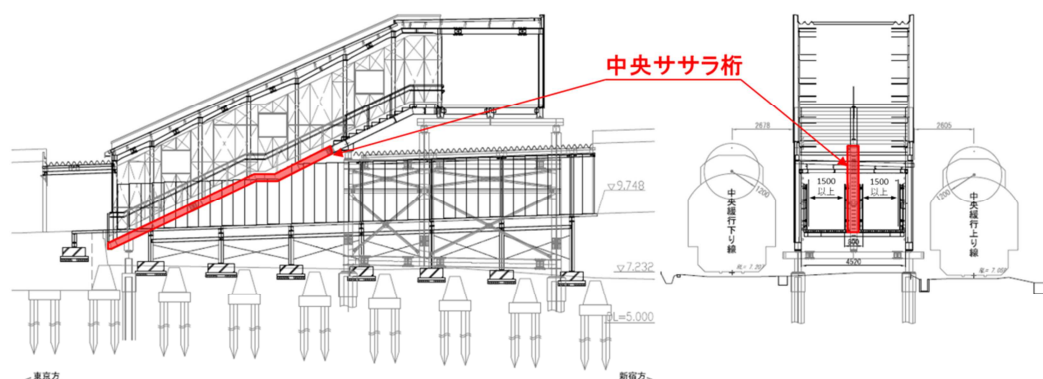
仮こ線橋階段部 中央ササラ桁設置時の側面図および断面図
